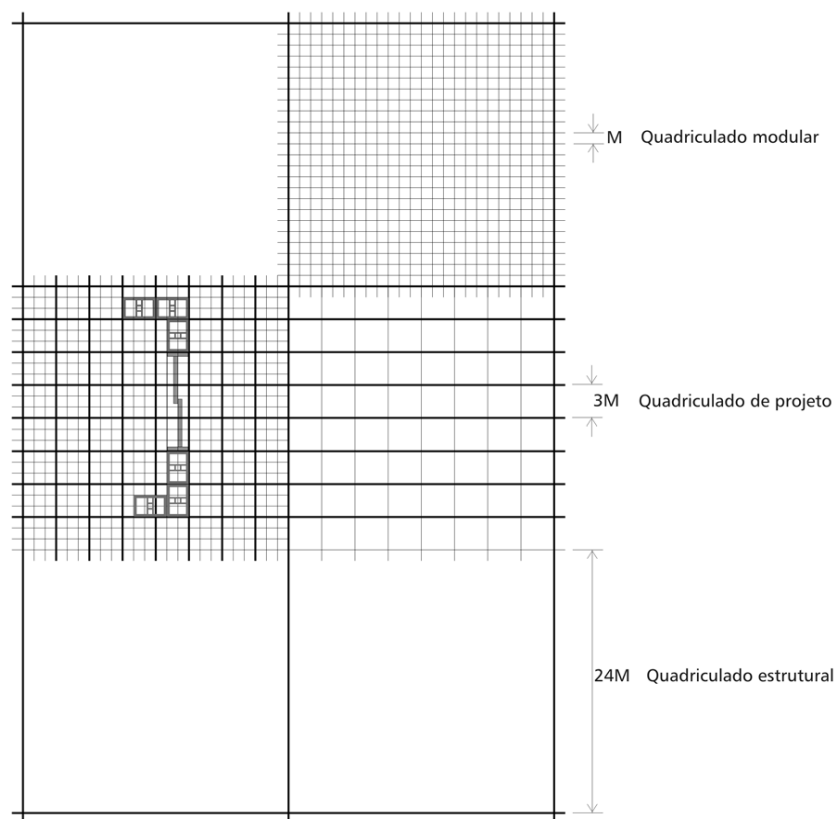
Exemplo da aplicação das malhas modulares GREVEN e BALDAUF (2007)
